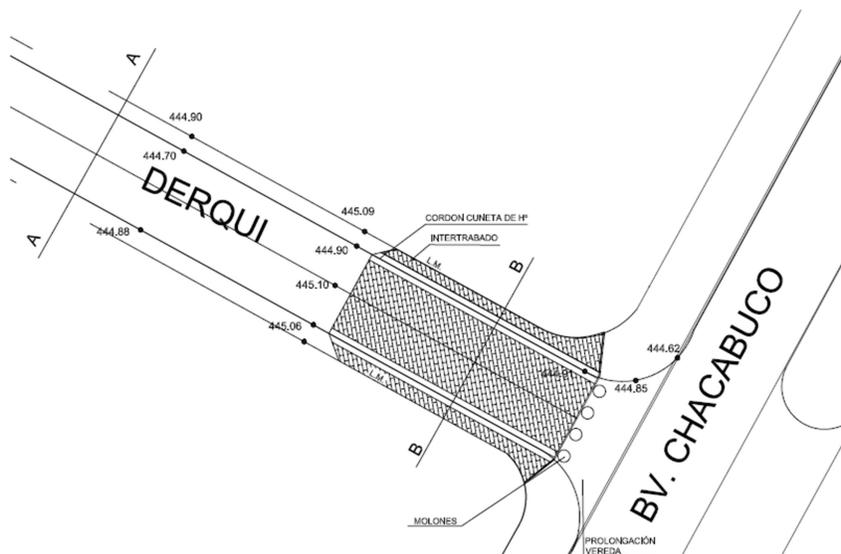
Detalle de la colocación de intertrabado calle Derqui.
